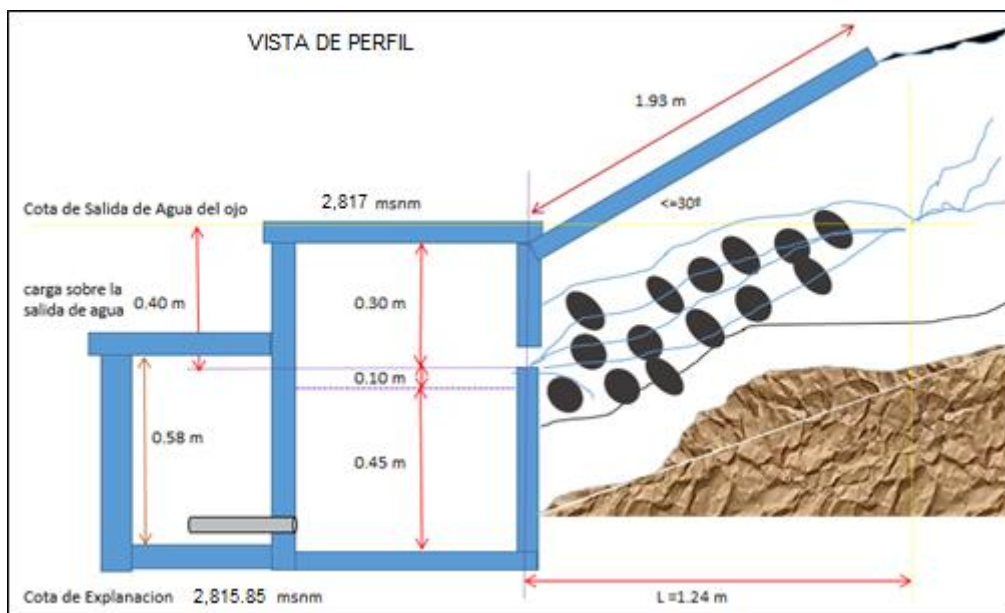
Pre dimensión hidráulica de la cámara húmeda 2
